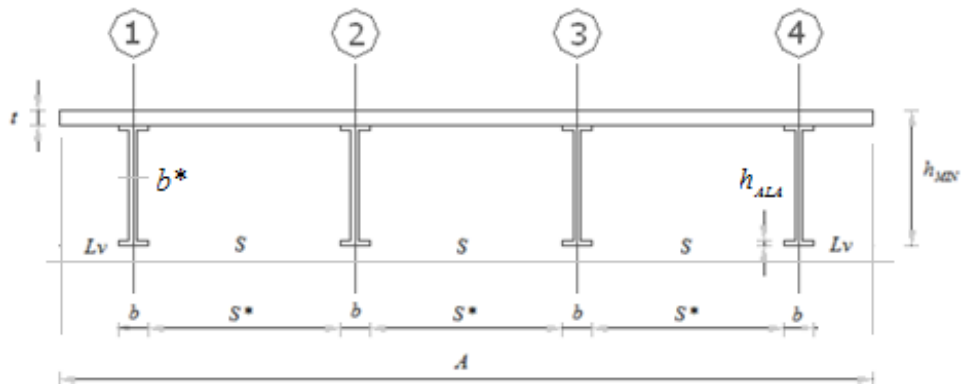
Nomenclatura en la sección compuesta de vigas longitudinales simplemente apoyadas de acero y tablero de hormigón armado
